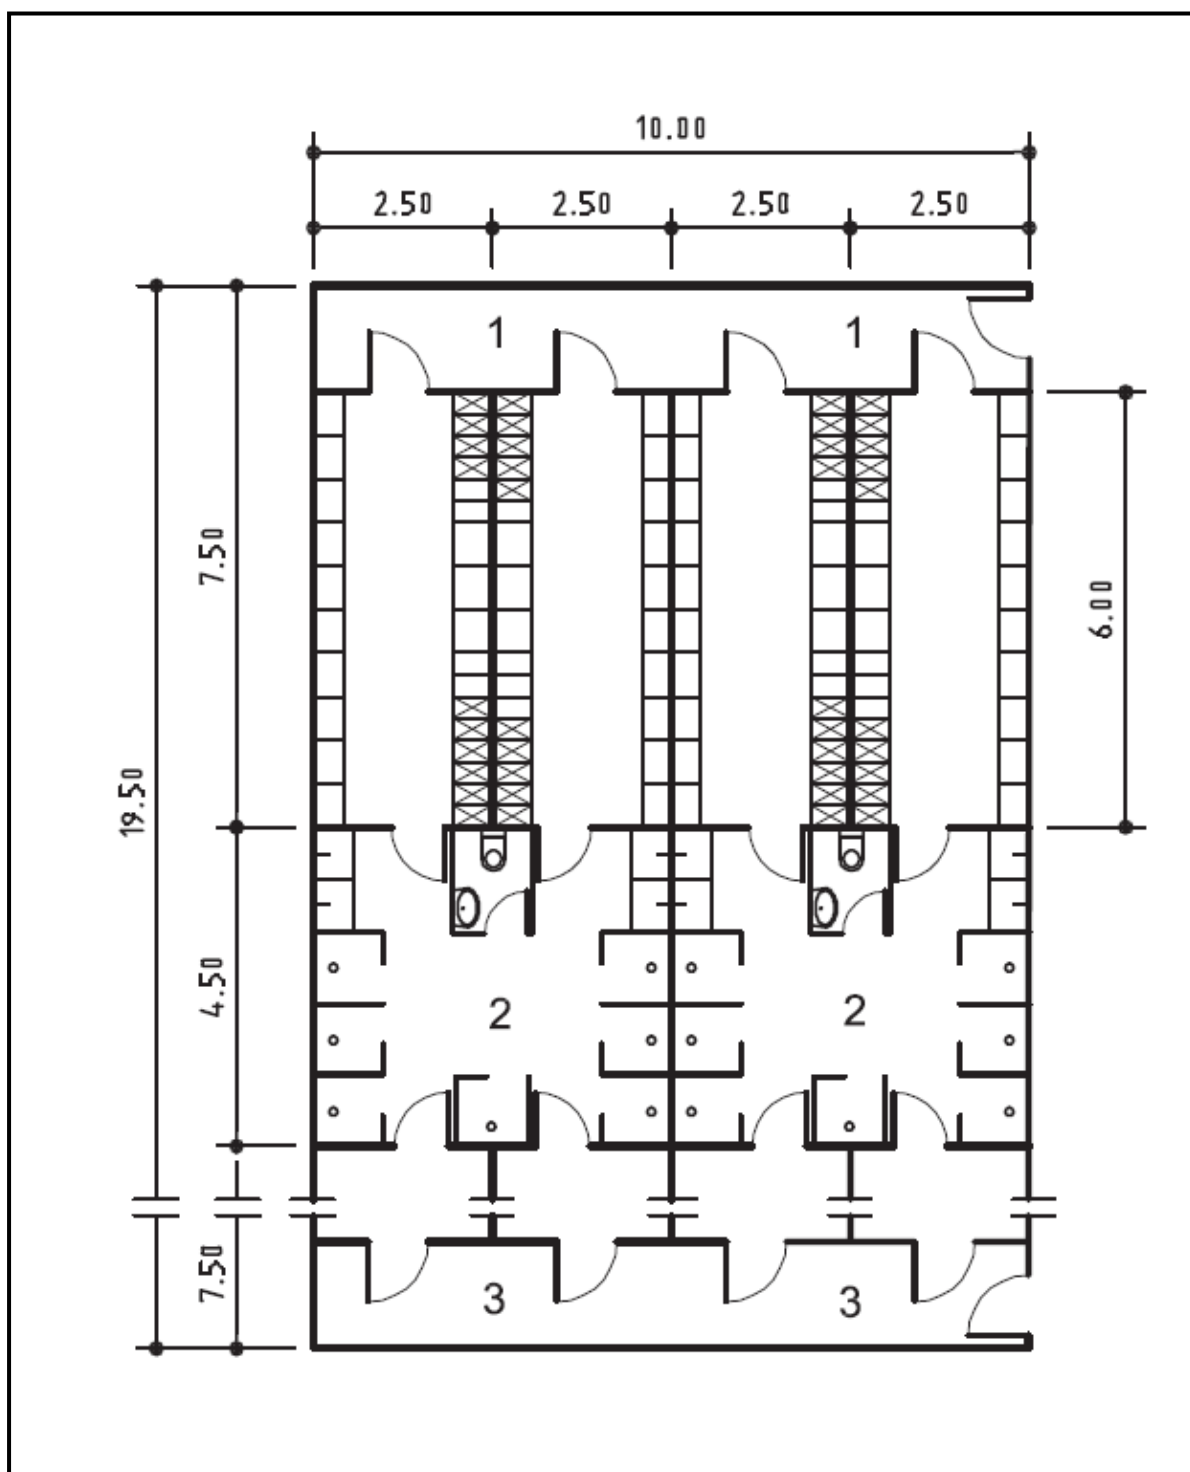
Exemple 4 pour vestiaires et sanitaires avec 2x36 places
